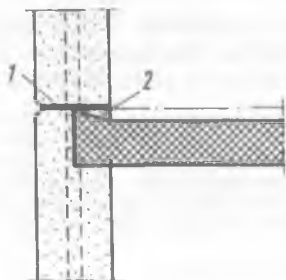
Соединение между несущей ячеистобетонной стеной и перекрытием, выполненным из монолитного бетона; торцу перекрытия придана специальная форма с уклоном для предотвращения попадания дождя в период строительства
